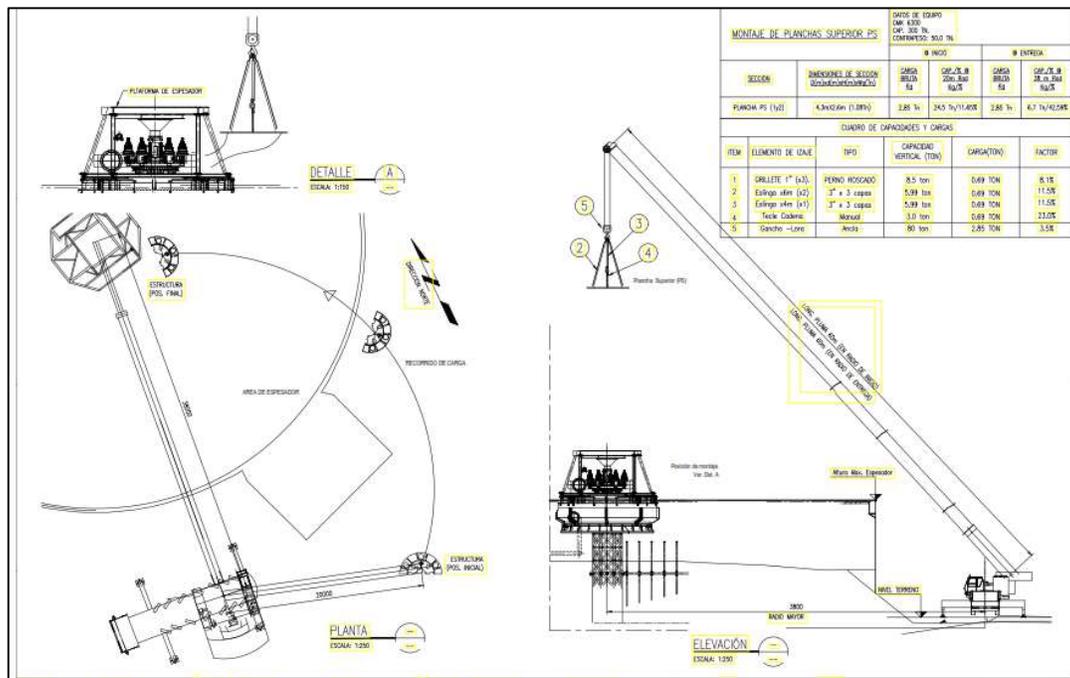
Imagen extraída de plan de izaje de Plancha superior (Anexo 6). Elaboración propia
